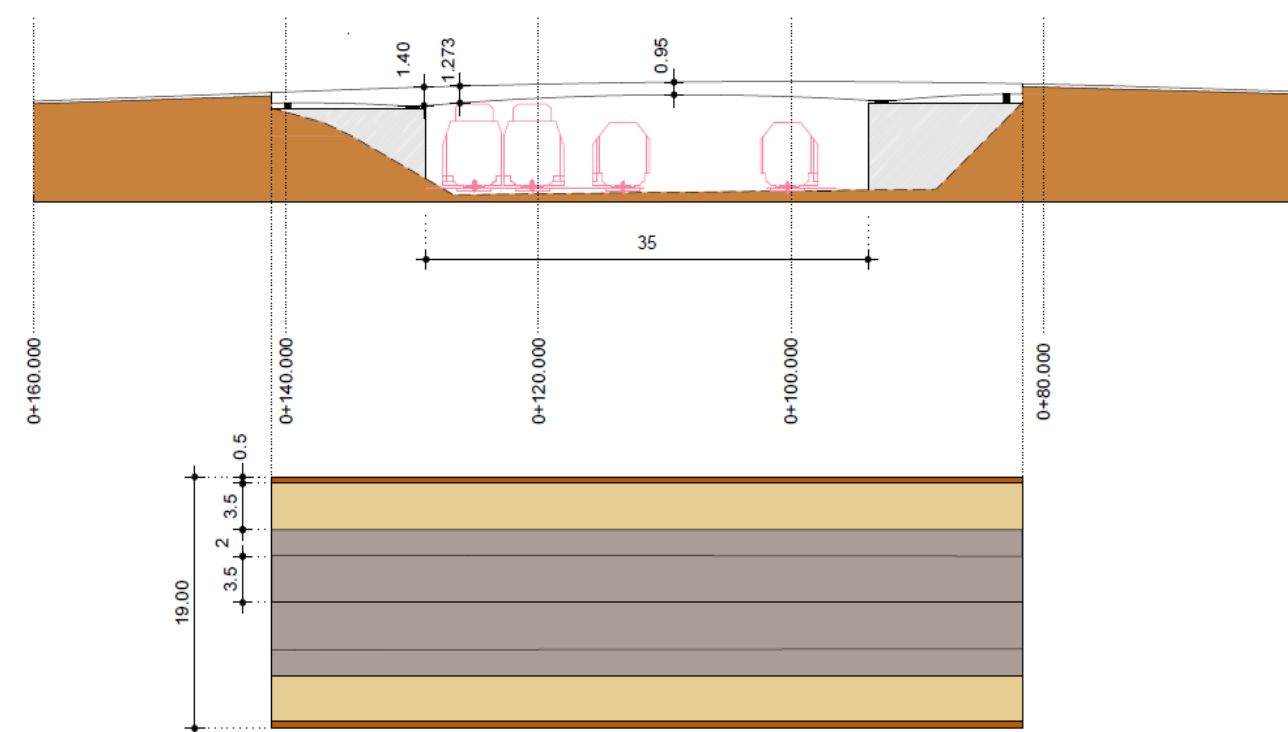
PLANTA Y ALZADO SOLUCIÓN 3.
